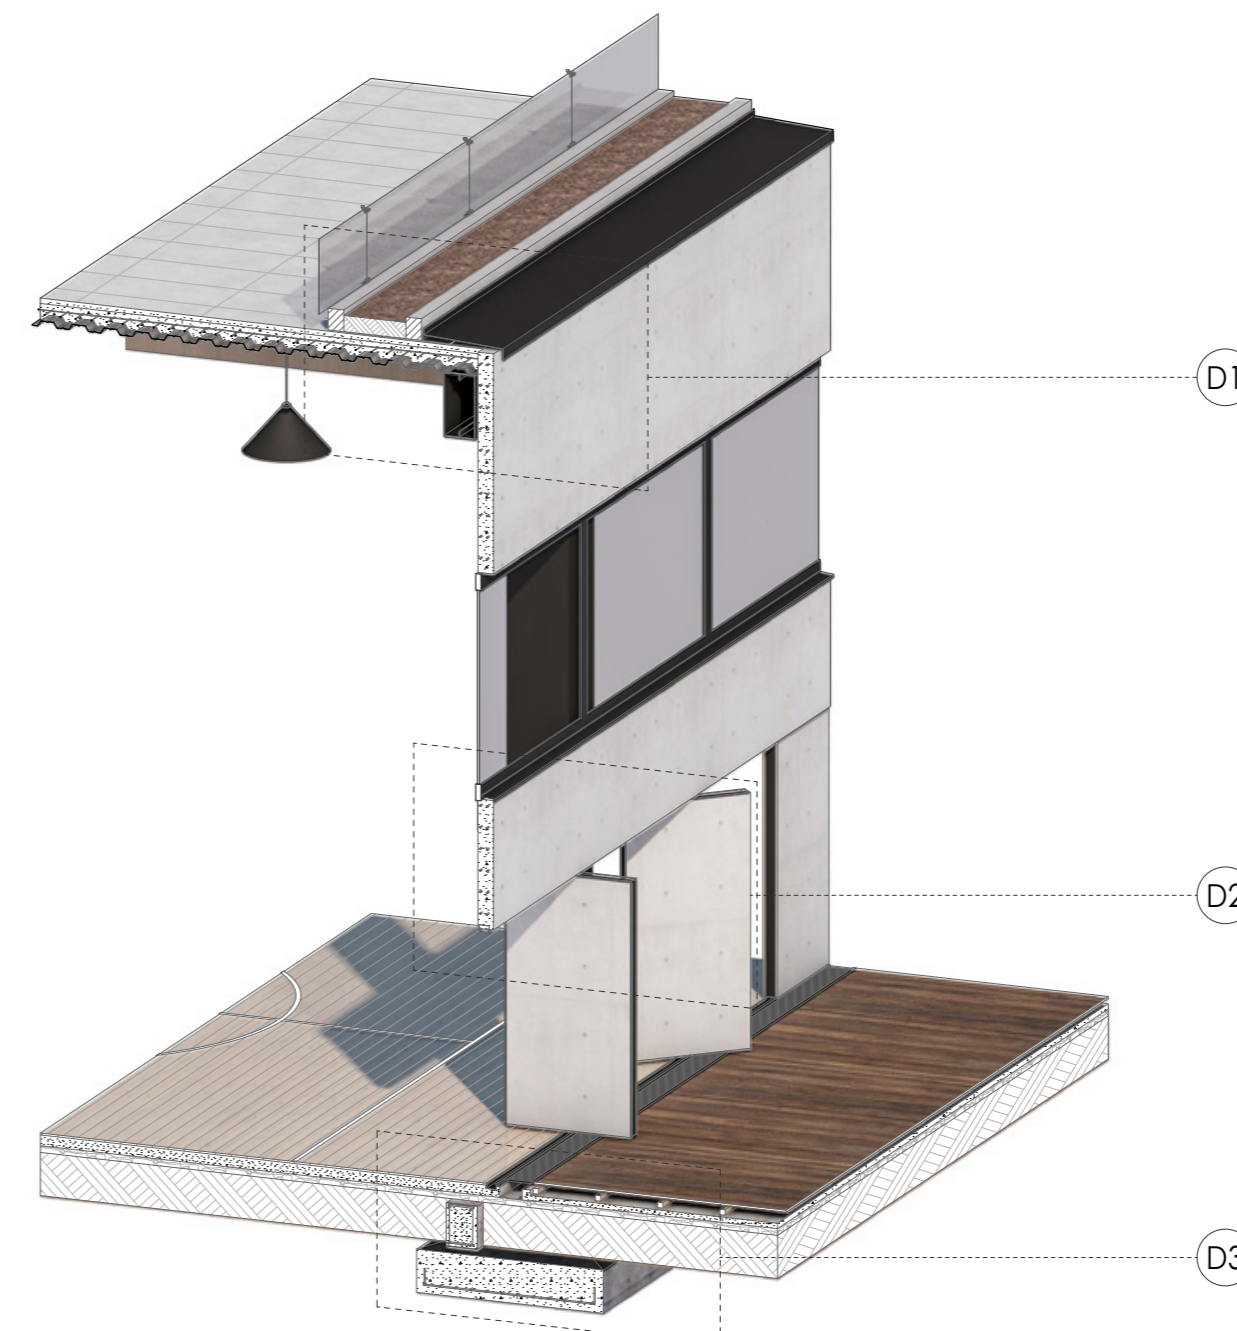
Sección constructiva Cancha multiuso | Fuente: Elaboración propia
